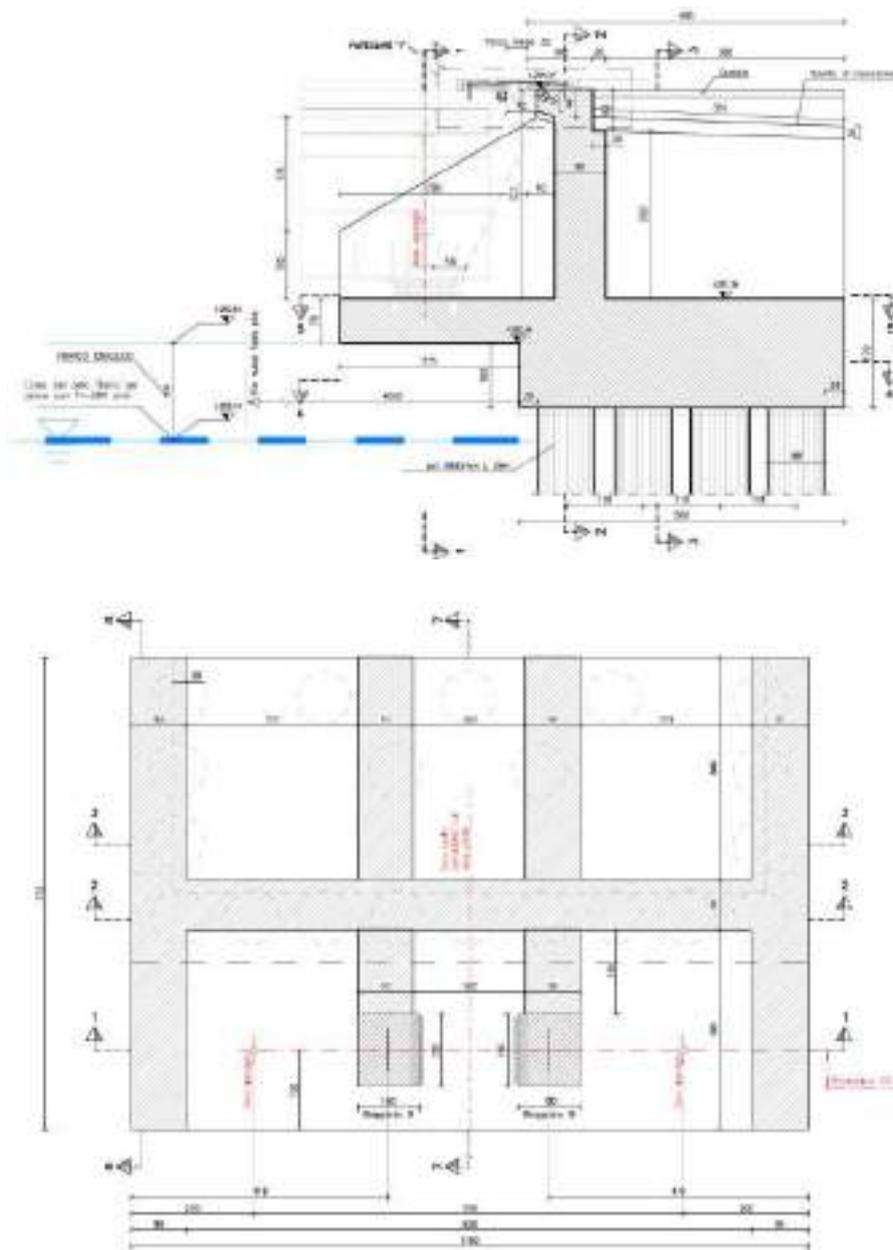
Nuove spalle: sezione trasversale e pianta.
